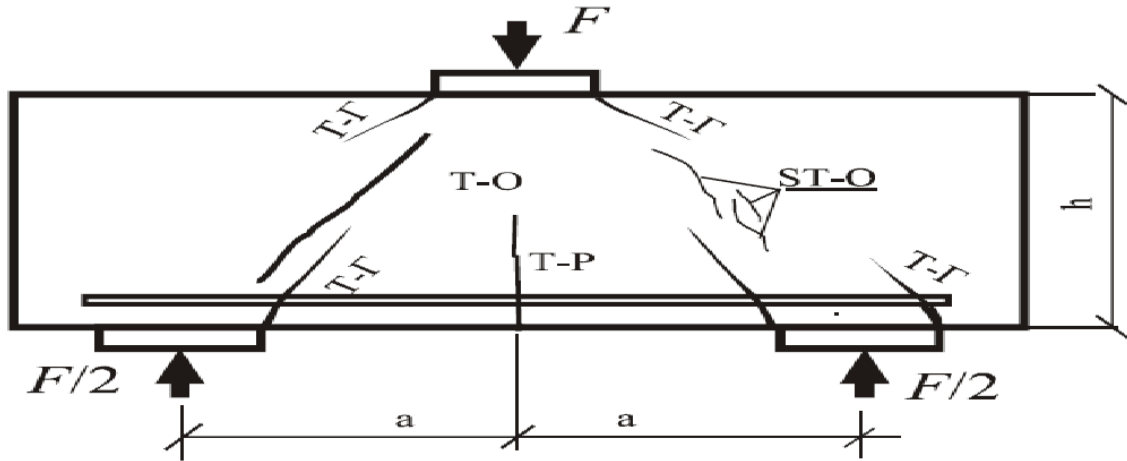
Классификация трещин в железобетонных балках
